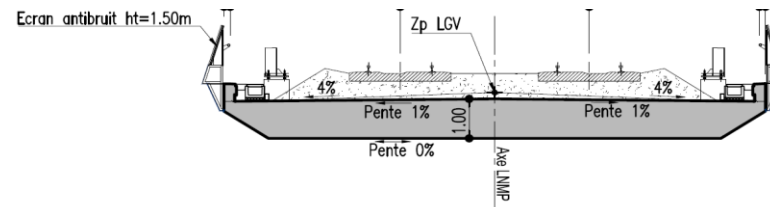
Exemple de coupe-type de pont dalle (source : INGEROP)
